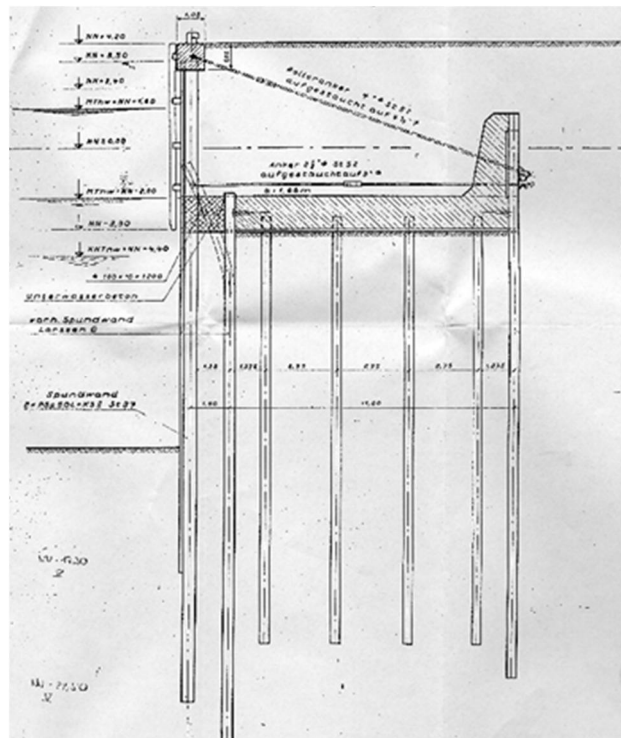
Fangedammkonstruktion Einfahrtsbauwerk nach dem Wiederaufbau
